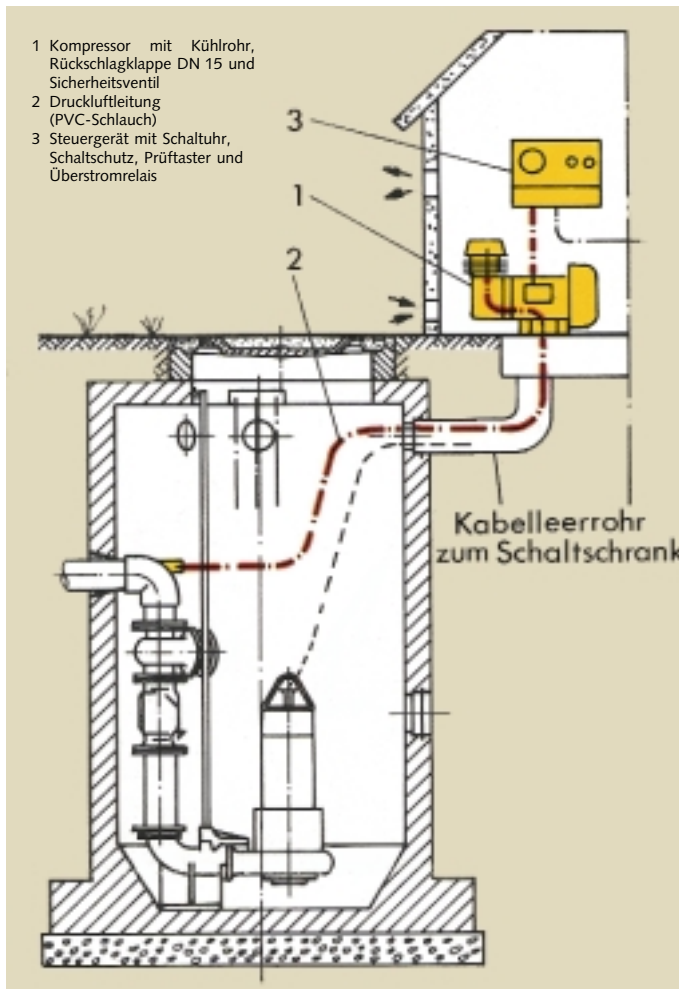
Abwasser-Sammelschacht für Erdeinbau mit Pumpstation und Druckrohr-Belüftungsanlage
